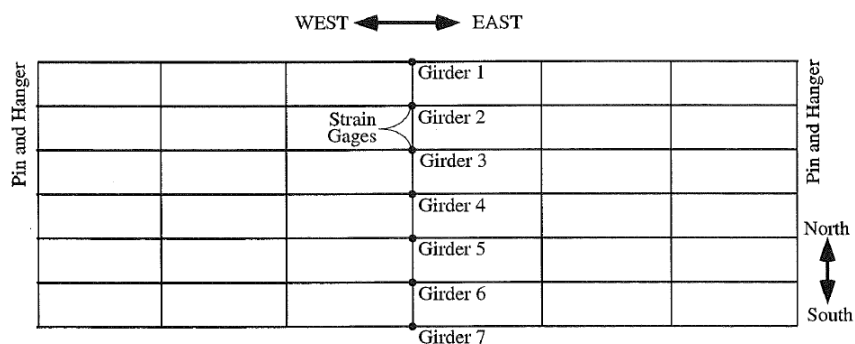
Planta de instrumentação da ponte (retirado de Nowak e Eon, 2001).
